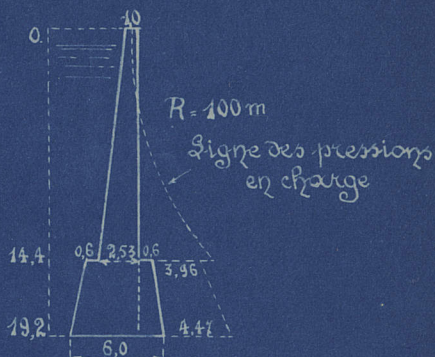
Elevation et coupe transversale du barrage de la Shoshone
